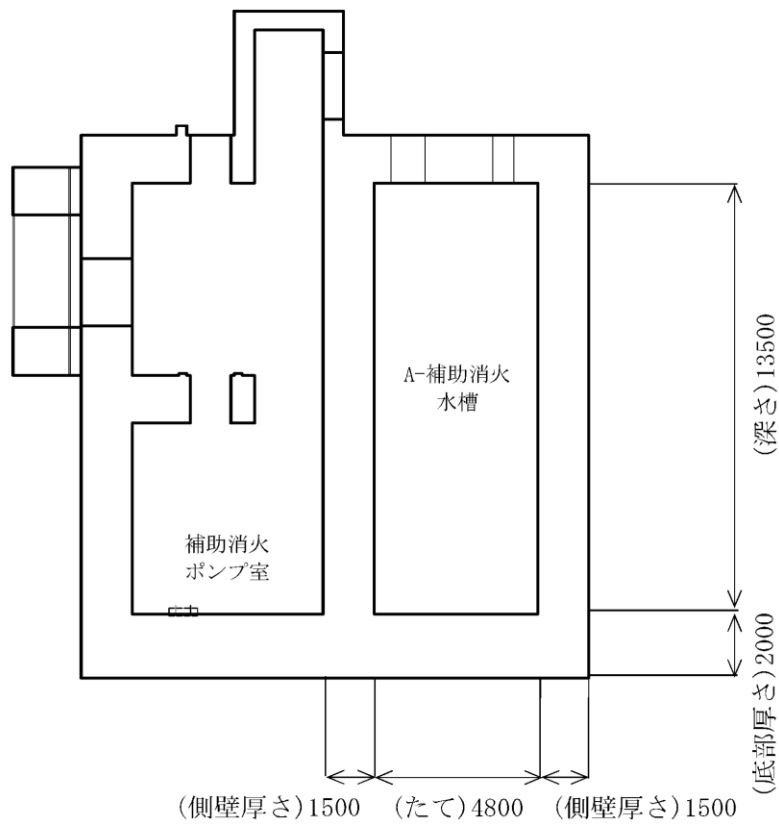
(2) 補助消火水槽 断面図 (B-B 断面)
